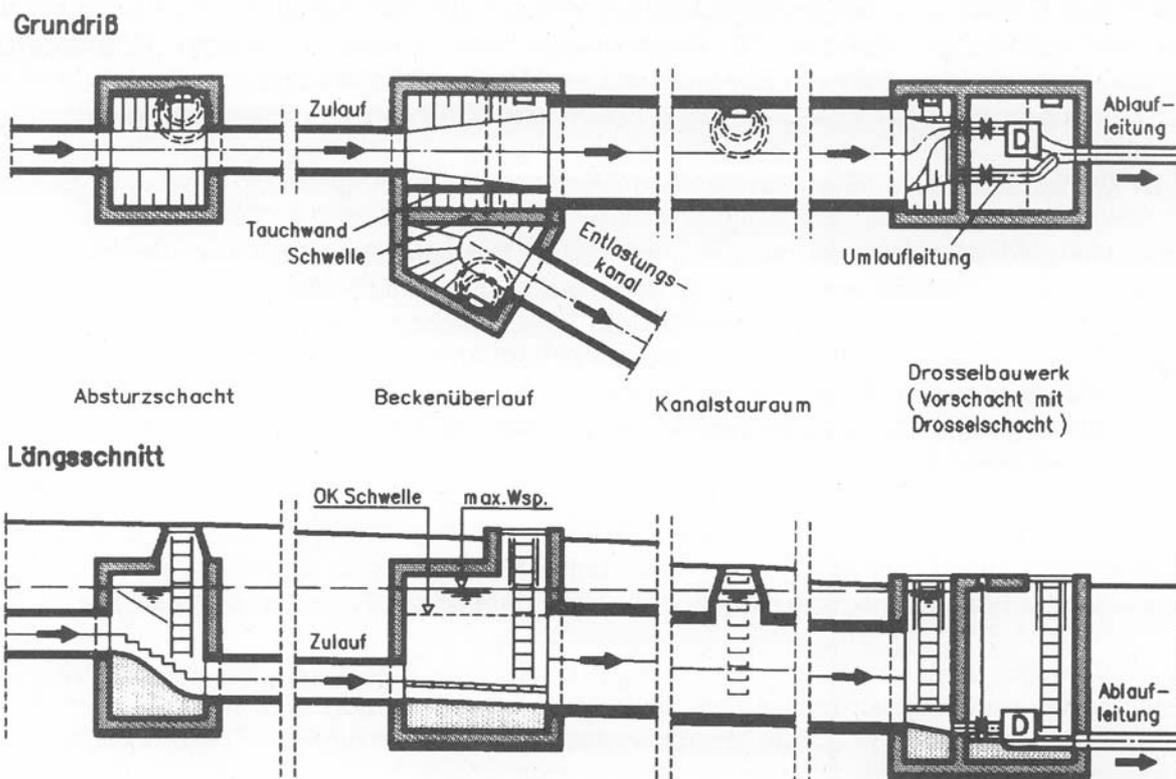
Stauraumkanal mit oberliegender Entlastung (SKO); Beckenüberlauf (BÜ) als seitlich angeströmtes Wehr (Streichwehr) mit einseitigem Überlauf und fester Schwelle; Drosselbauwerk mit Vorschacht
